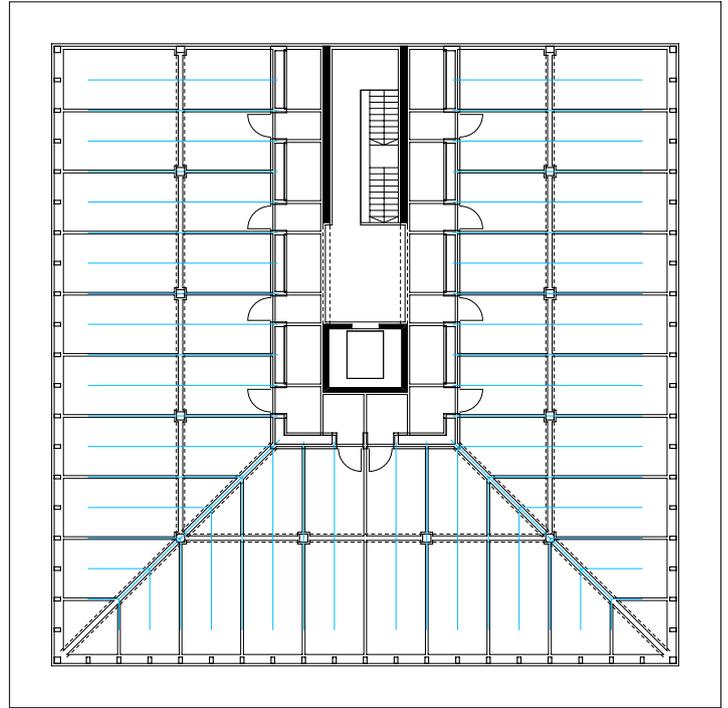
Lage der Sprinklerleitungen im Grundriß (blaue Linien)
